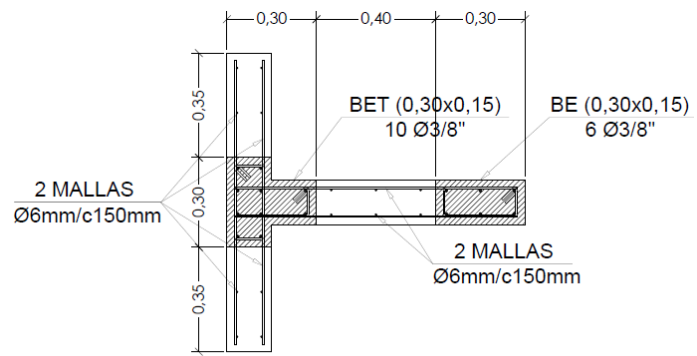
Distribución del refuerzo en planta del muro TW1.2.
